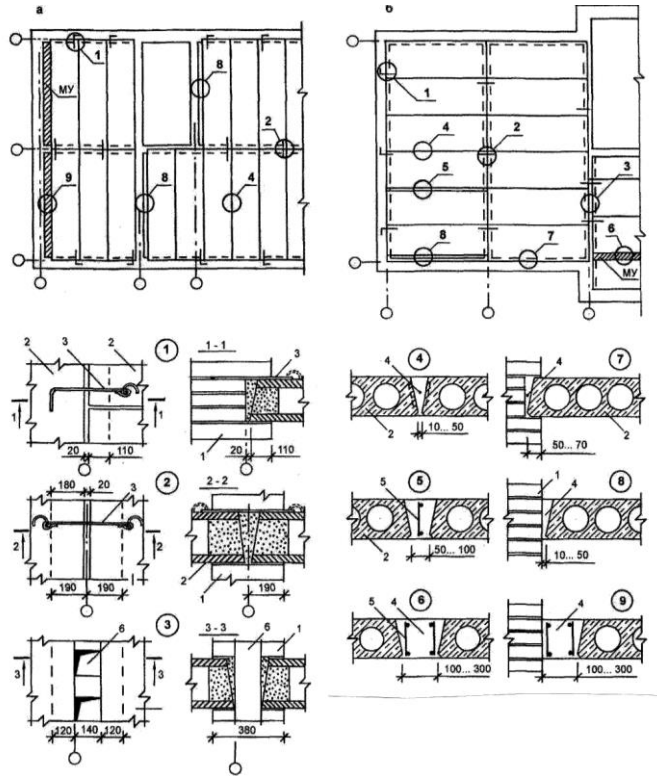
Фрагмент схемы расположения сборных железобетонных элементов перекрытия в зданиях с кирпичными стенами:
